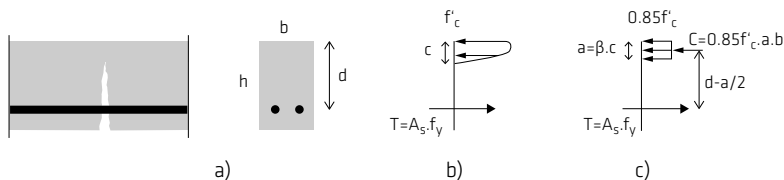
Schematische Darstellung des Spannungsblocks für ein gerissenes Stahlbeton-Biegeelement ohne Fasern: a) Querschnitt eines Stahlbetonträgers; b) Tatsächliche Verteilung der Normalspannungen; c) Vereinfachte Verteilung der Normalspannungen.
